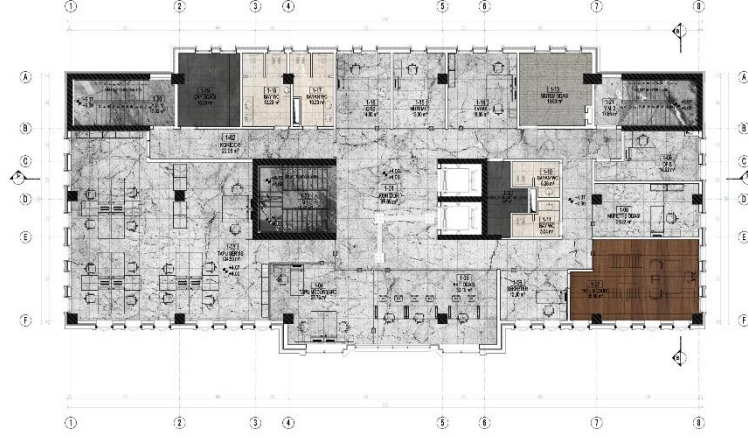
Bodrum kat planı, uygulama projesi (Çelik, 2021)
